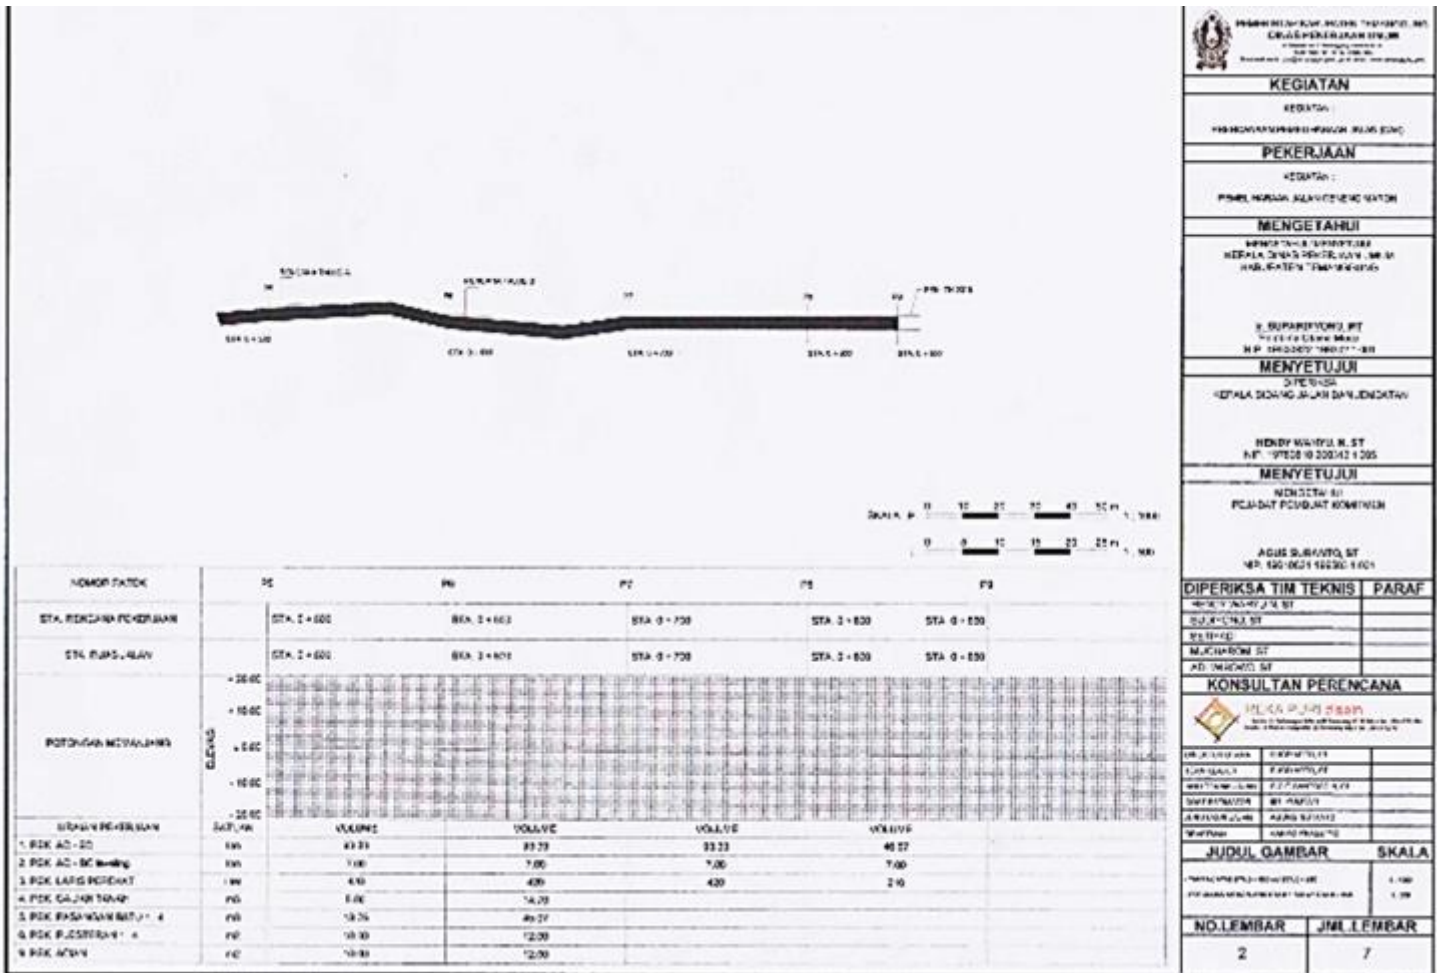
4 Asbuilt Drawing sta.1+500 s/d 1+700
